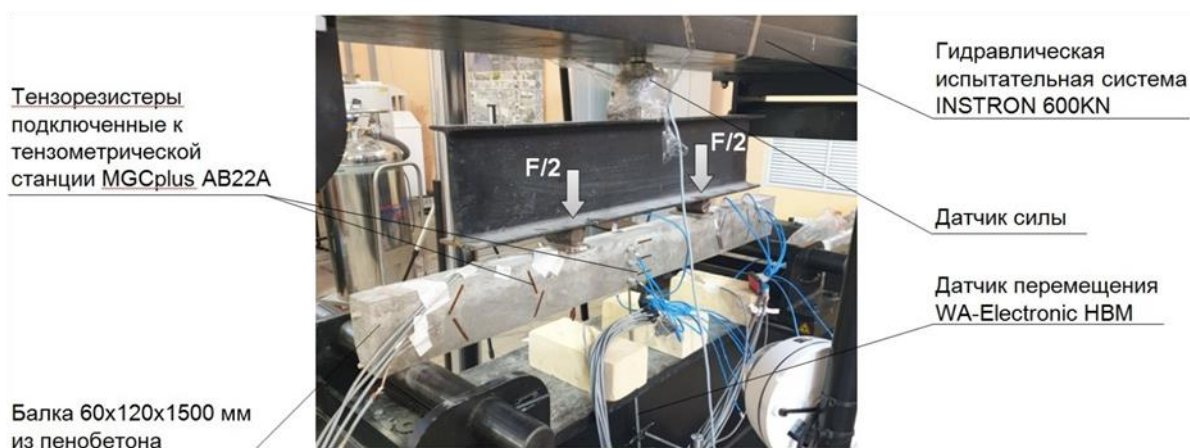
Общий вид балки из пенобетона в испытательной установке Instron 600 KN
